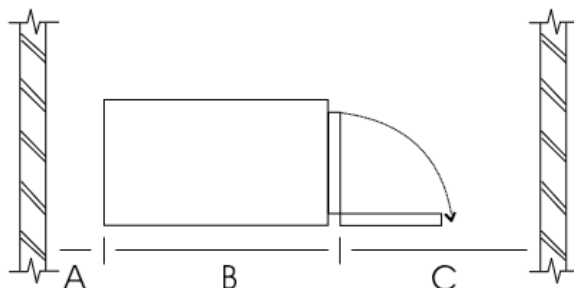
Distanze minime dalle pareti (Tab. 3)
